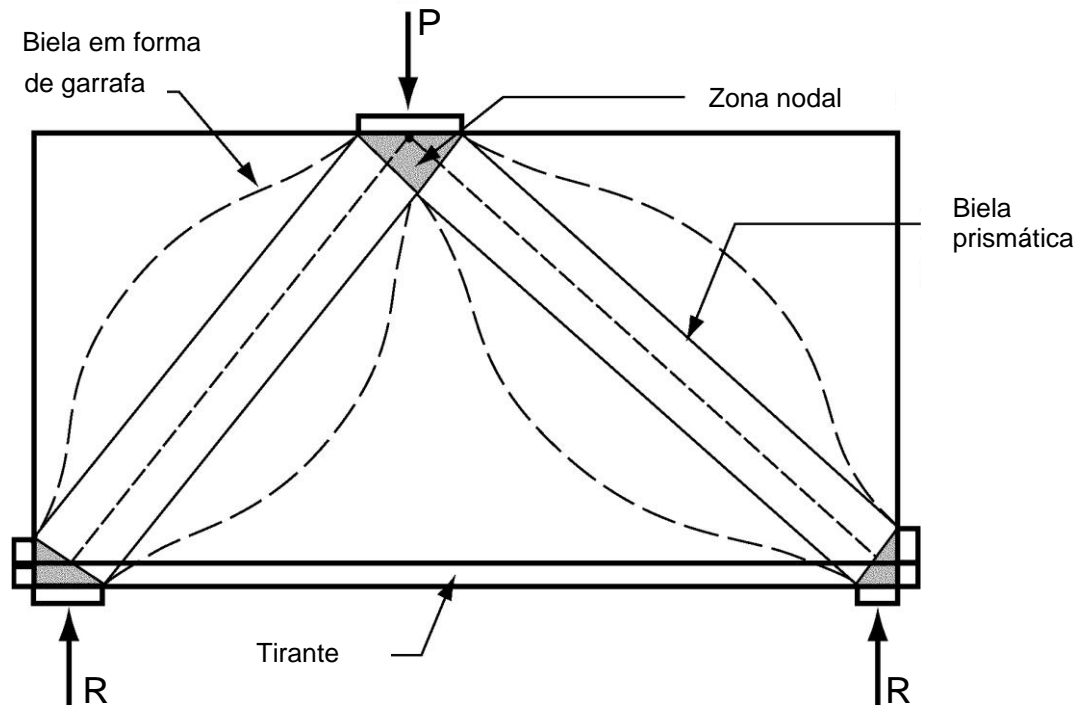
Exemplificação dos conceitos de zona nodal, bielas prismáticas e em forma de garrafa e tirante usuais em vigas altas (Adaptada de ACI 318:2002)
